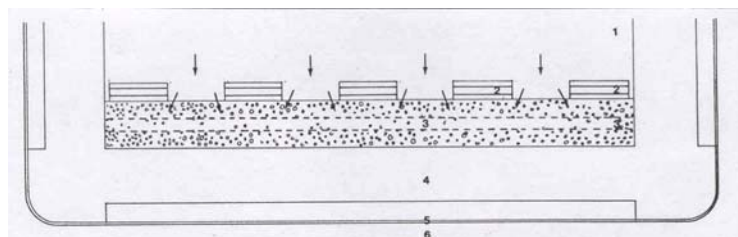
Zanja de infiltración con alimentación superficial en un estacionamiento. 1.- Estacionamiento, 2.- Soleras discontinuas, 3.- Zanja, 4.- Vereda, 5.- Cuneta, 6.- Calle.
